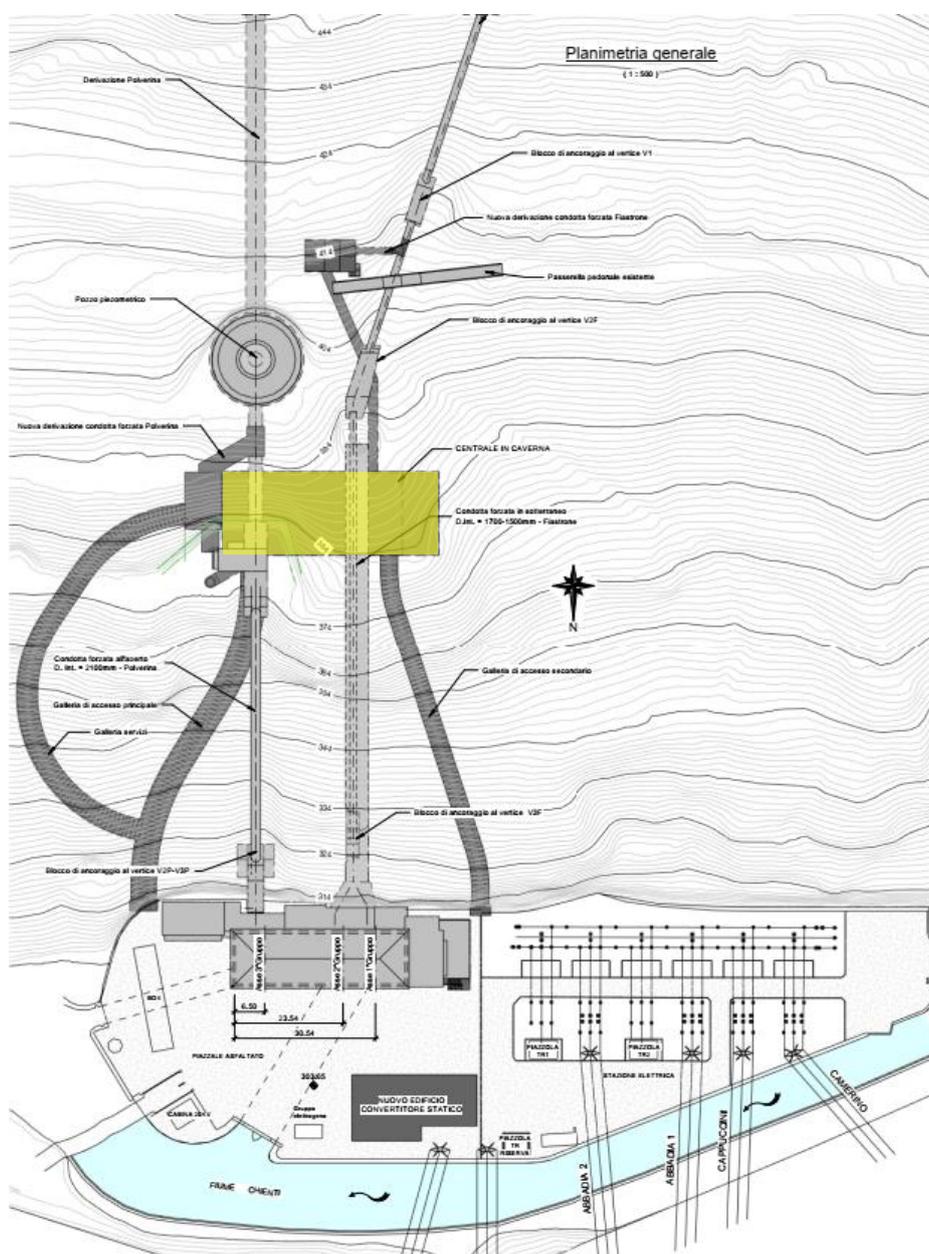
planimetria di progetto - nuova caverna di centrale Valcimarra II (in giallo)
